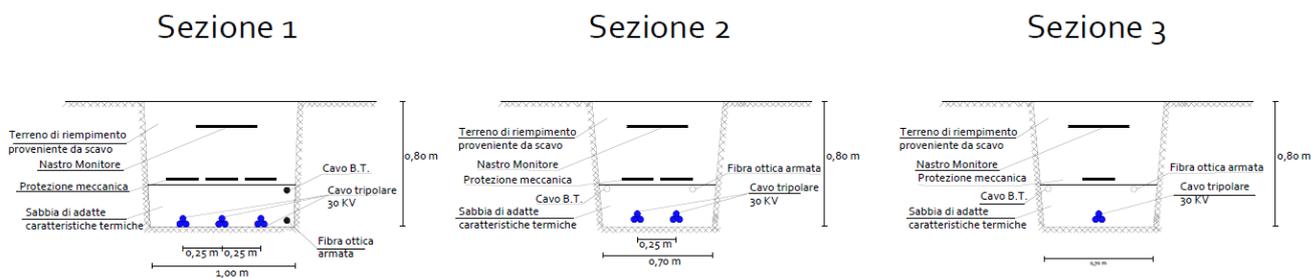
Sezione della trincea di scavo interna all'area d'impianto
